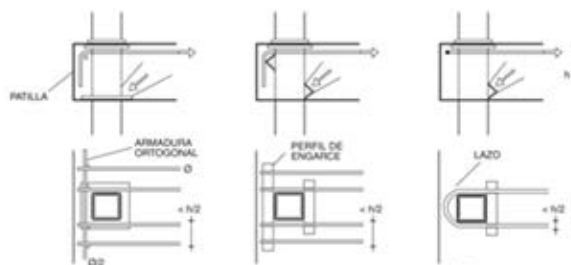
Armaduras superiores en nudo extremo con soporte metálico
